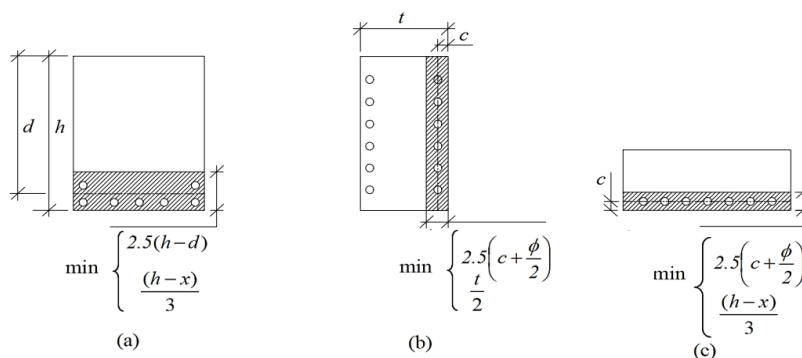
Determinação da área de betão efetiva para: a) vigas; b) elementos em tração; c) lajes. Adaptado de (CEB-FIP, 1993).
